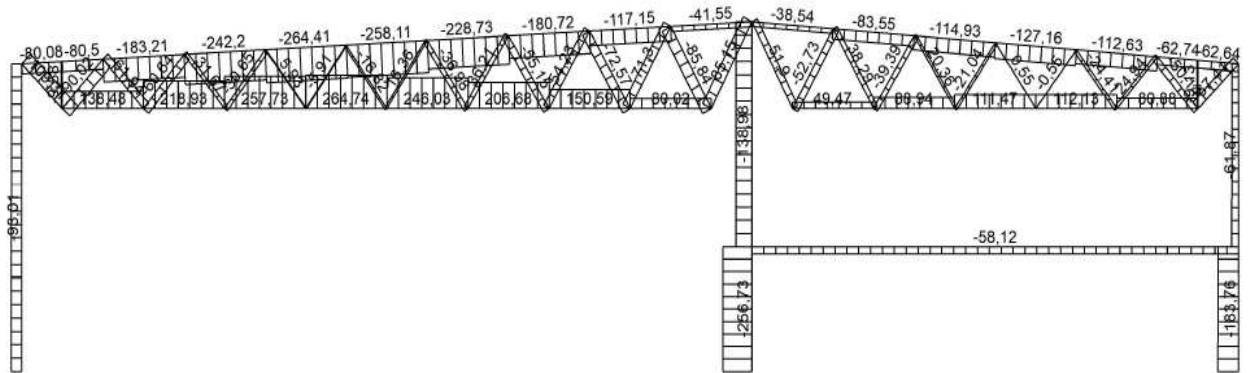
Эпюры продольных усилий N (кН) от расчетного сочетания нагрузок
